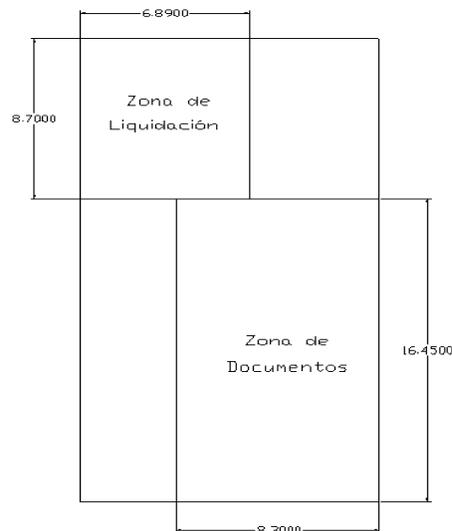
Diagrama esquemático de la distribución por Área de Trabajo Planta Baja – Área del Galpón (Unidades-mts).
